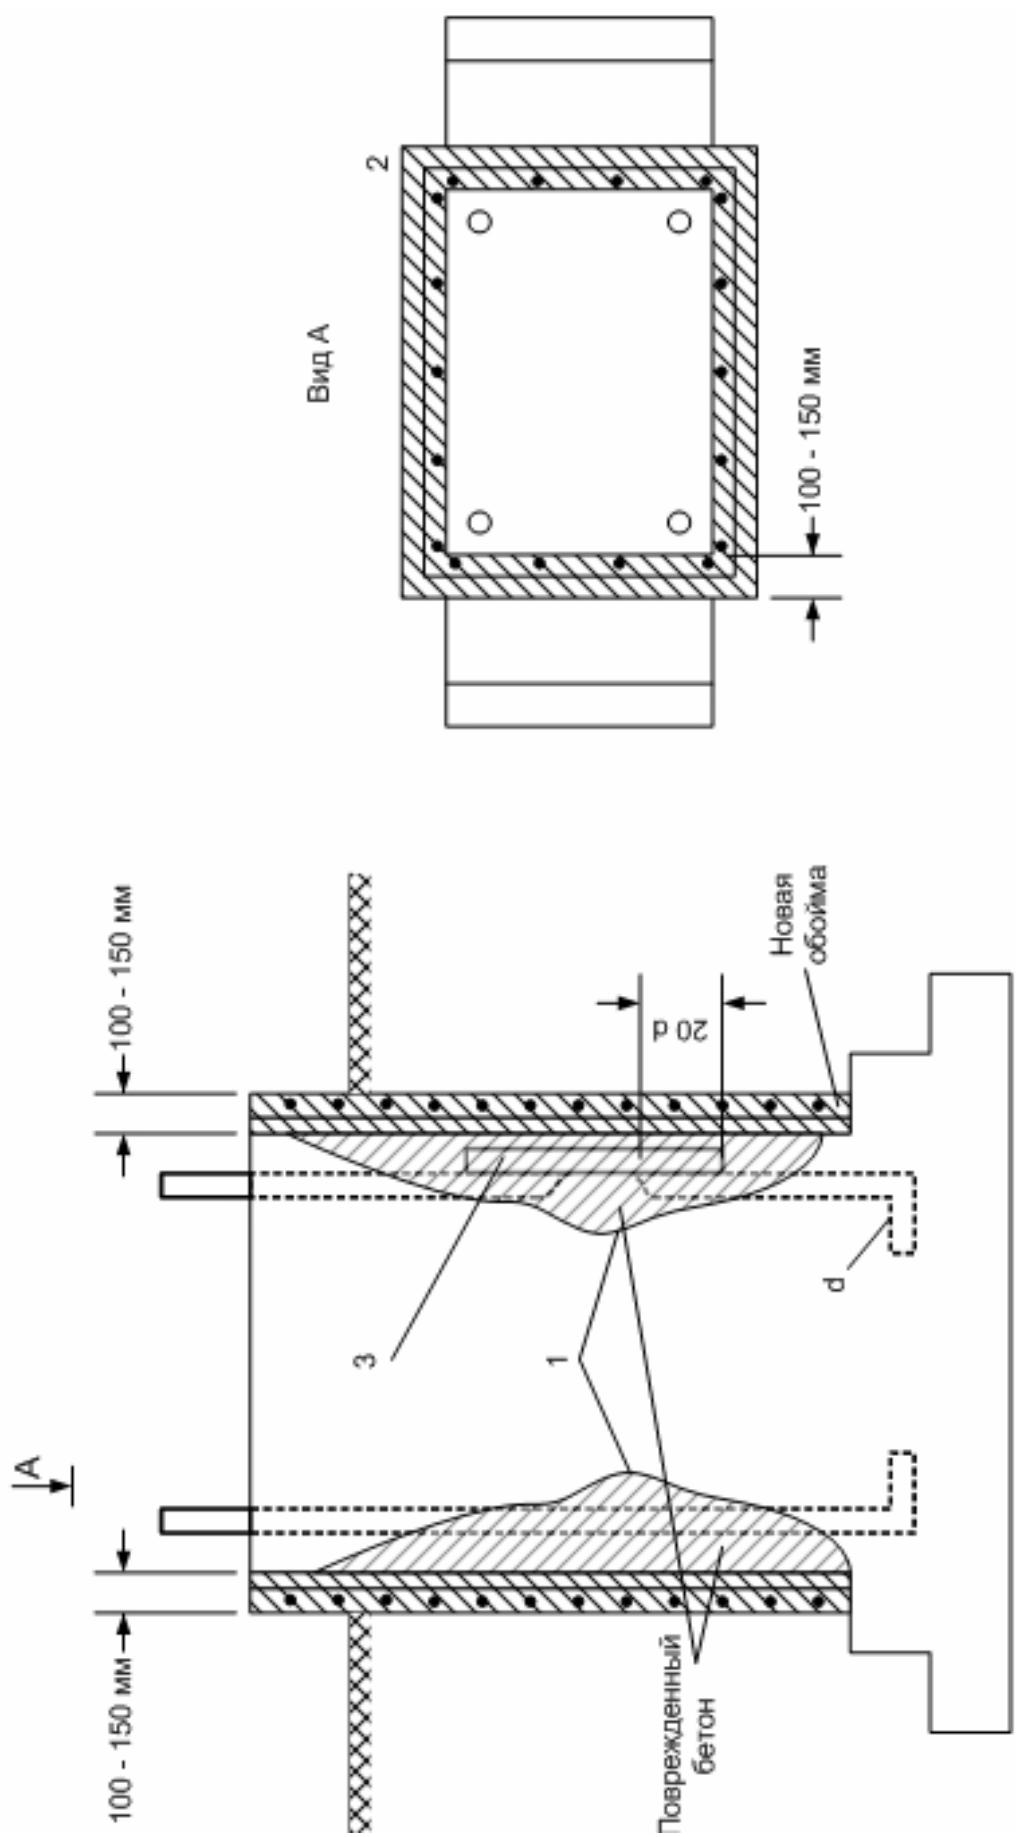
Ремонт фундамента гибкой поперечины с усилением анкерного болта:
